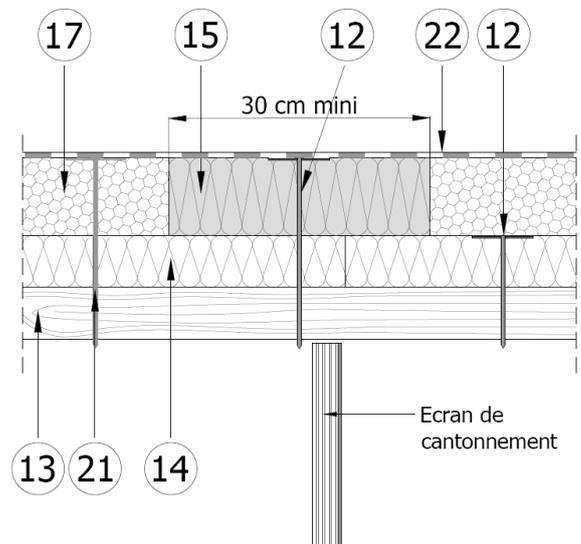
Exemple de calfeutrement horizontal contre un mur
